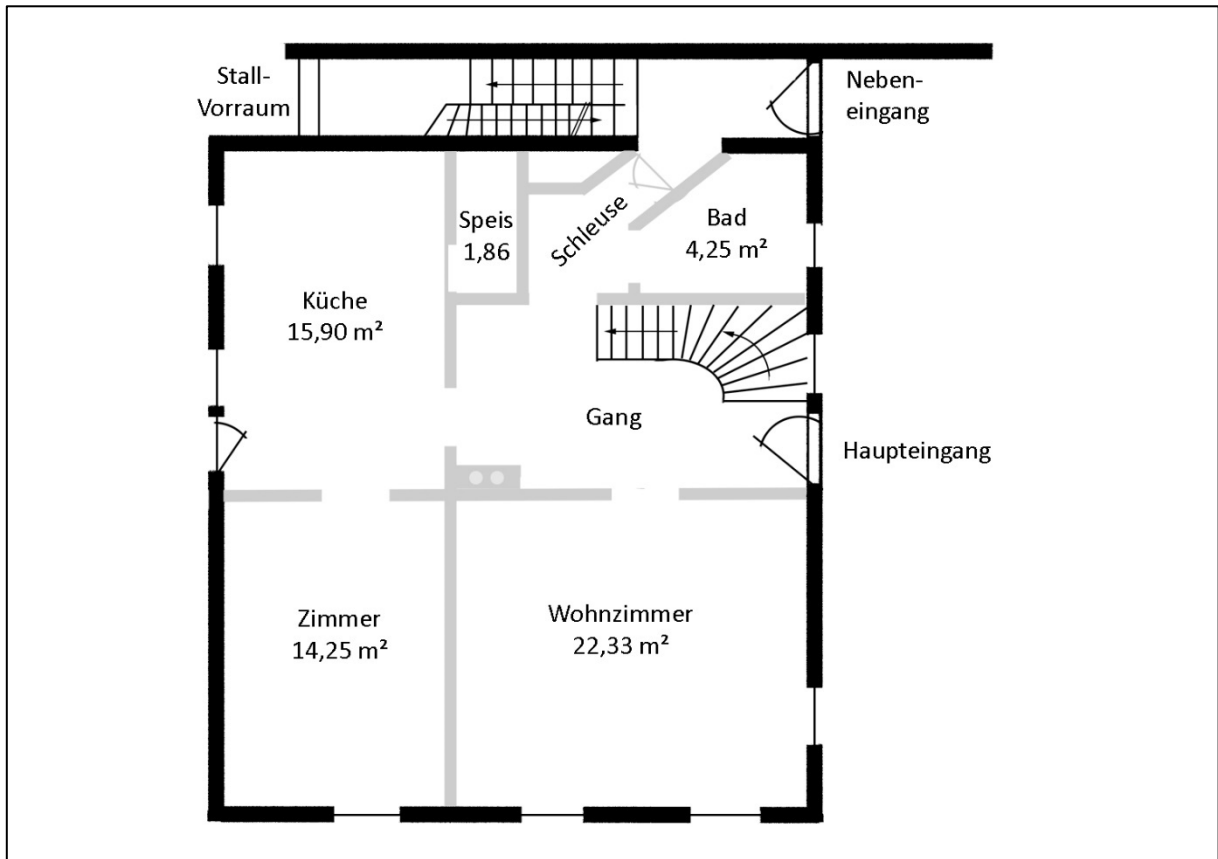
schematischer Grundriss des Erdgeschoßes
